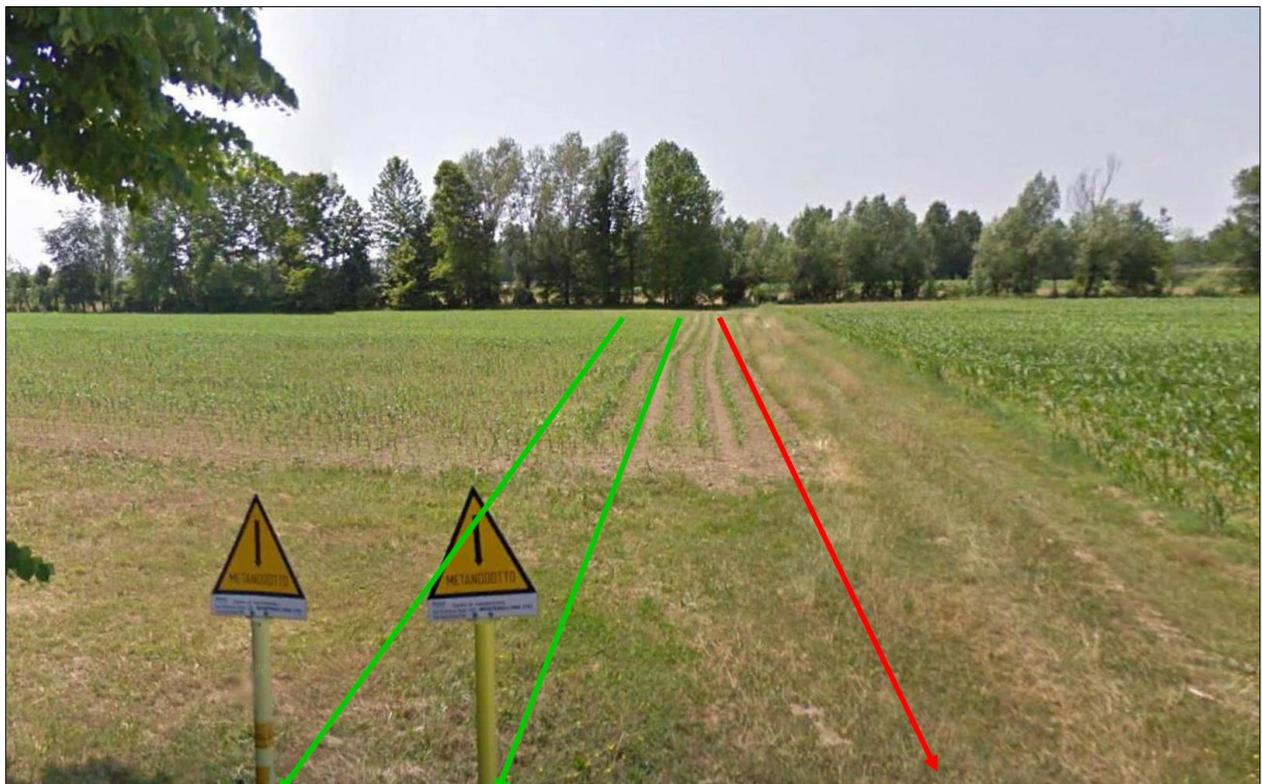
Vista del Rio Storta attraversato dalle condotte in progetto e in dismissione
